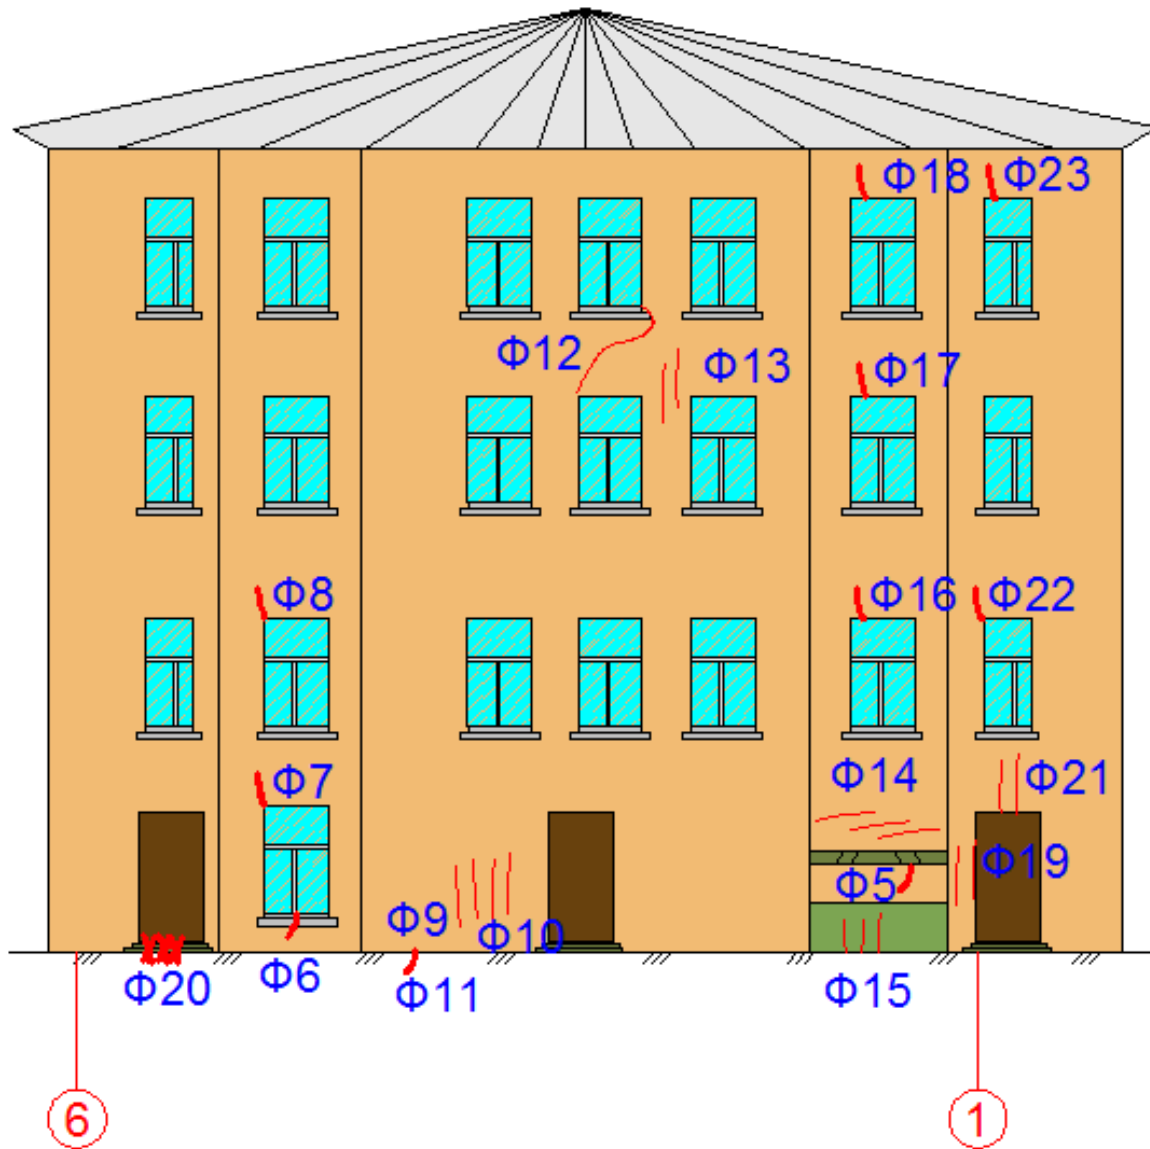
Схема дефектов фасад по оси «Ж». Фасад со стороны внутреннего двора.
